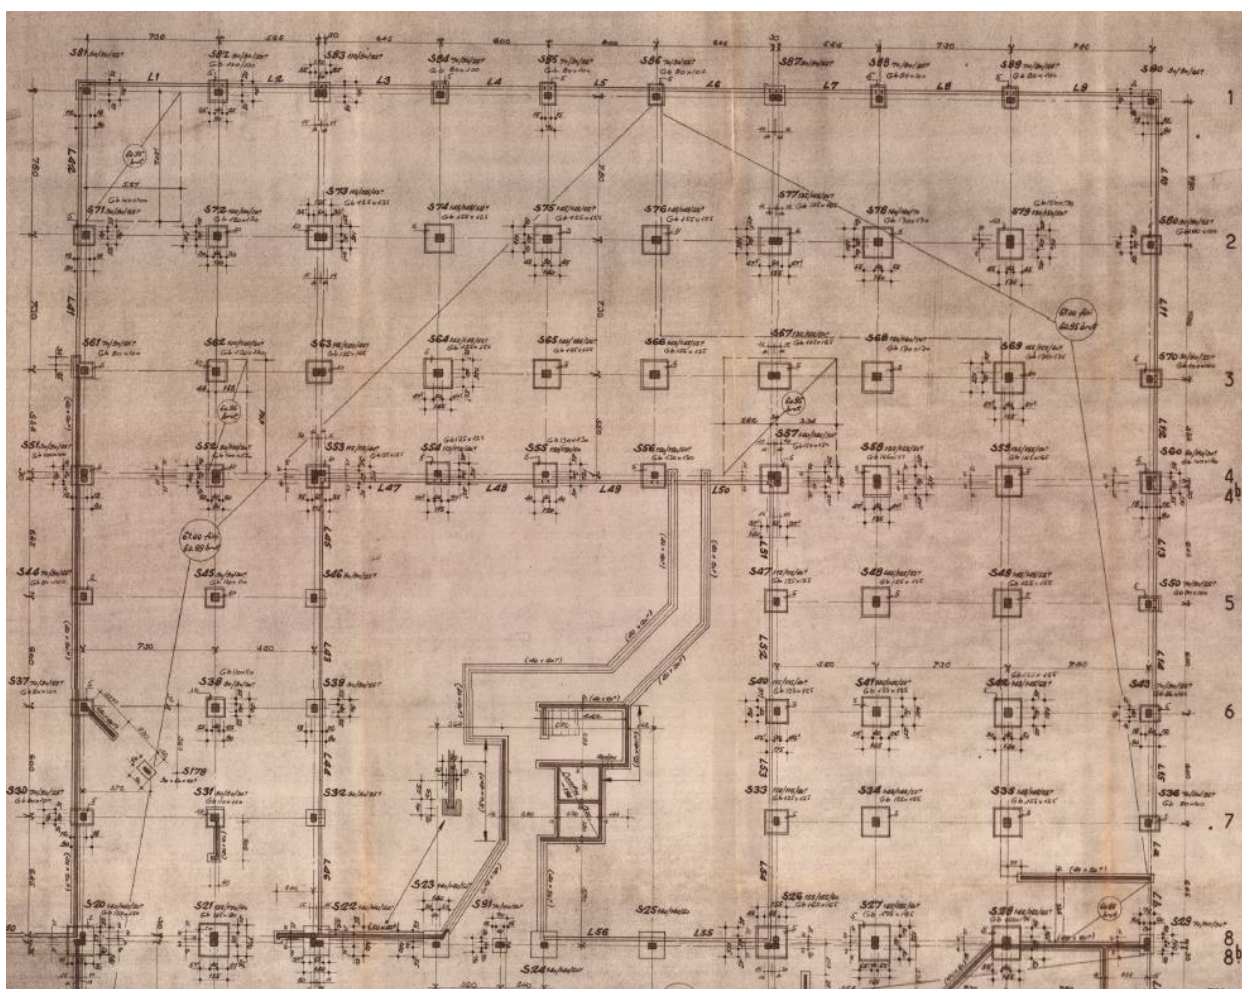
Extrait plan ferrailage dalle Plancher haut RDC (zones b, c, d, e et zone a)
